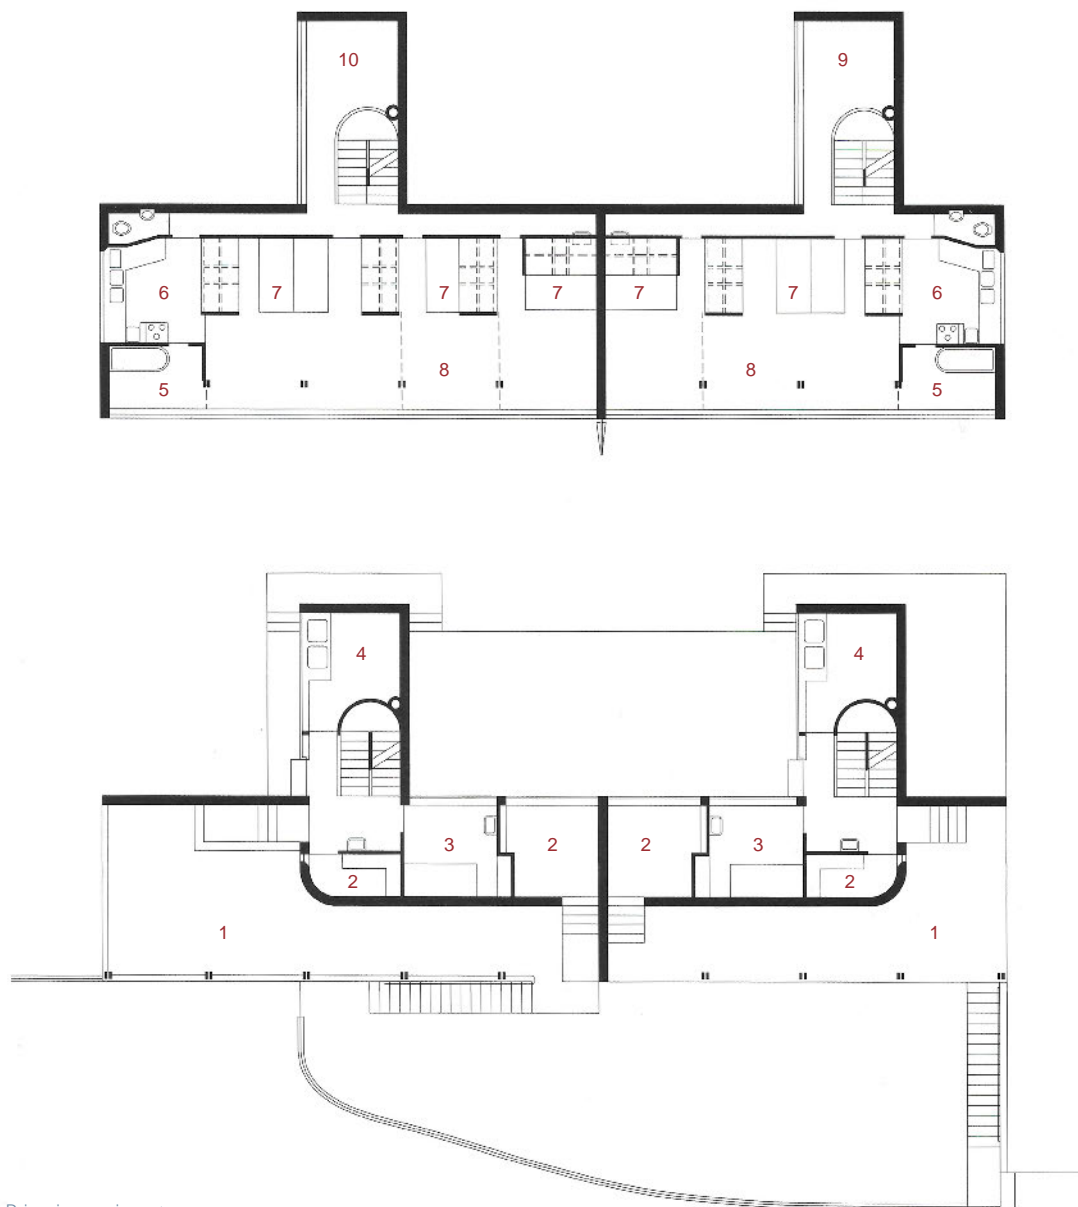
Plantas Segundo e Primeiro pavimentos.
